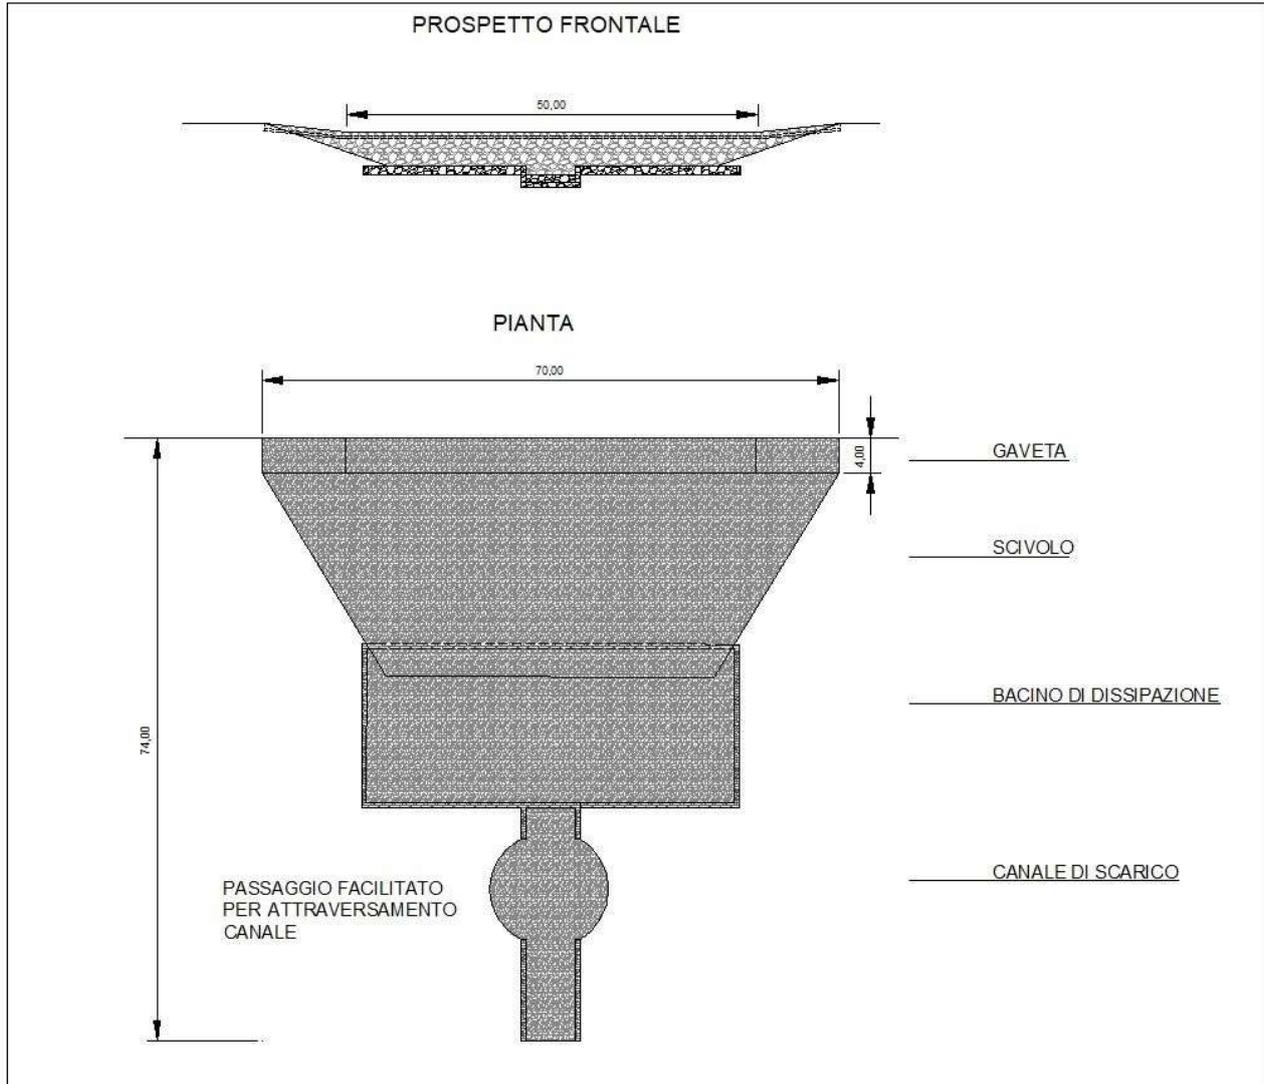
Prospetto frontale e pianta dello sfioratore per il lago Fo.Ma.
